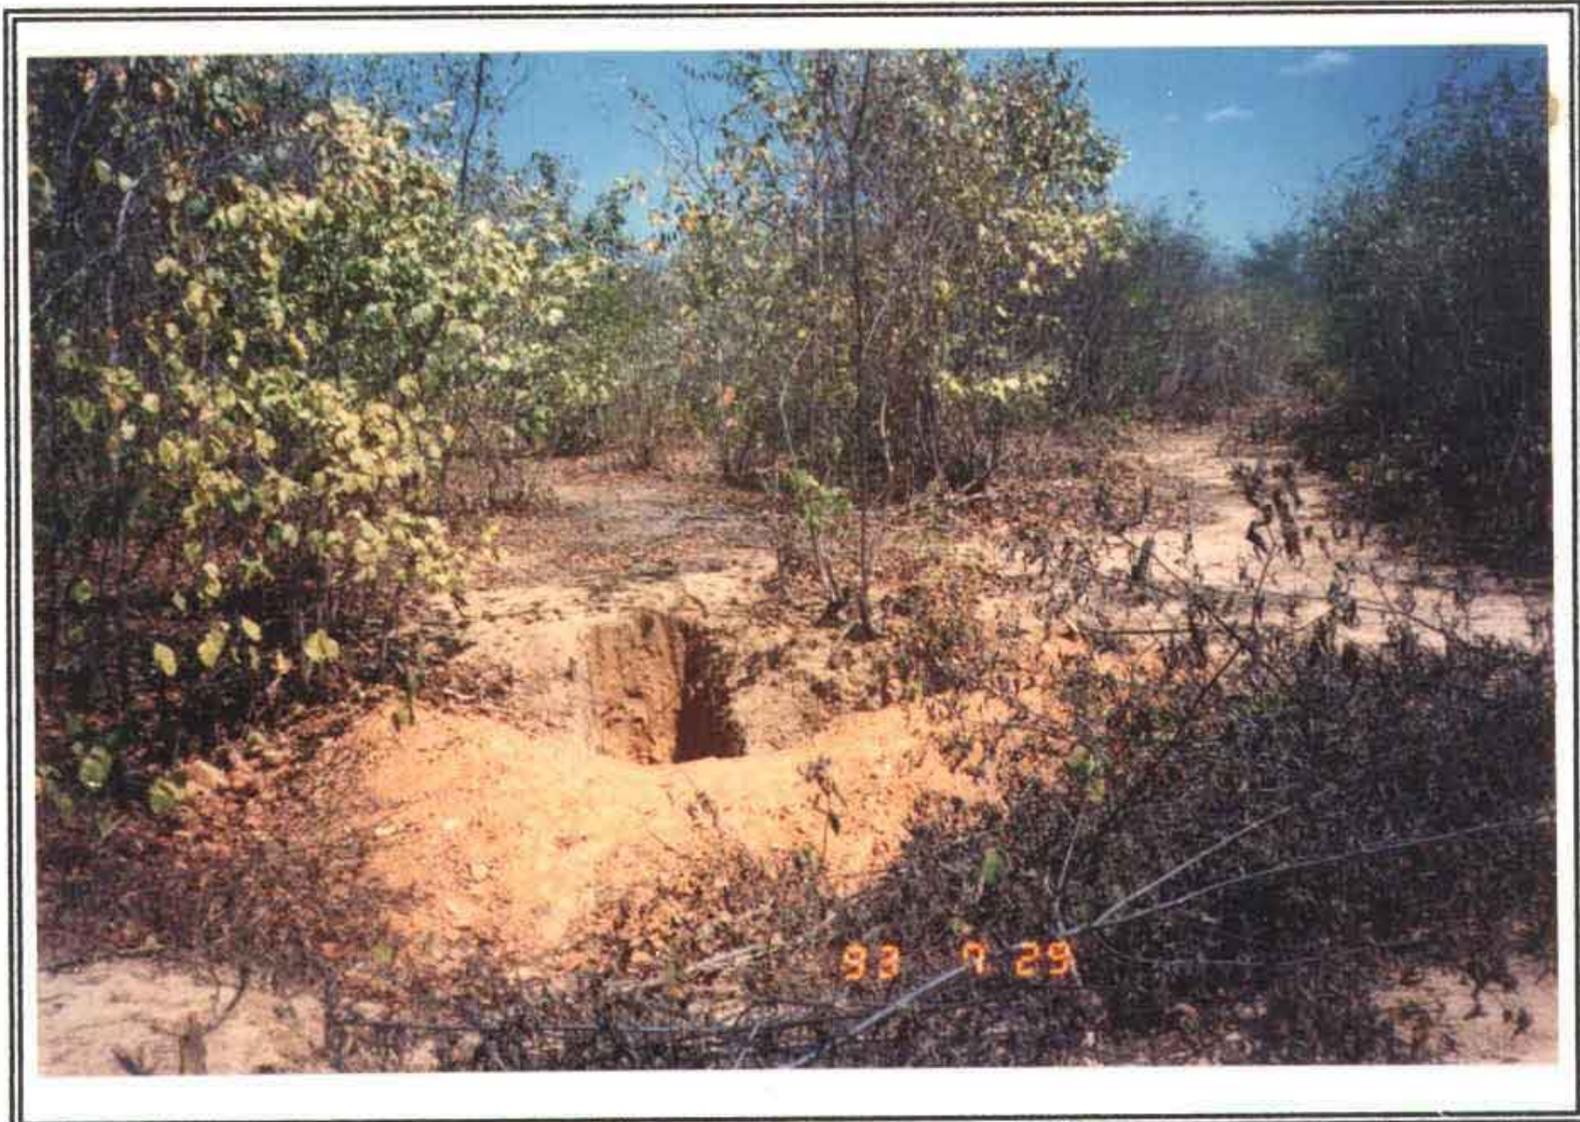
Vista de uma área escolhida para jazida terrosa, vendo-se um furo de sondagem.
